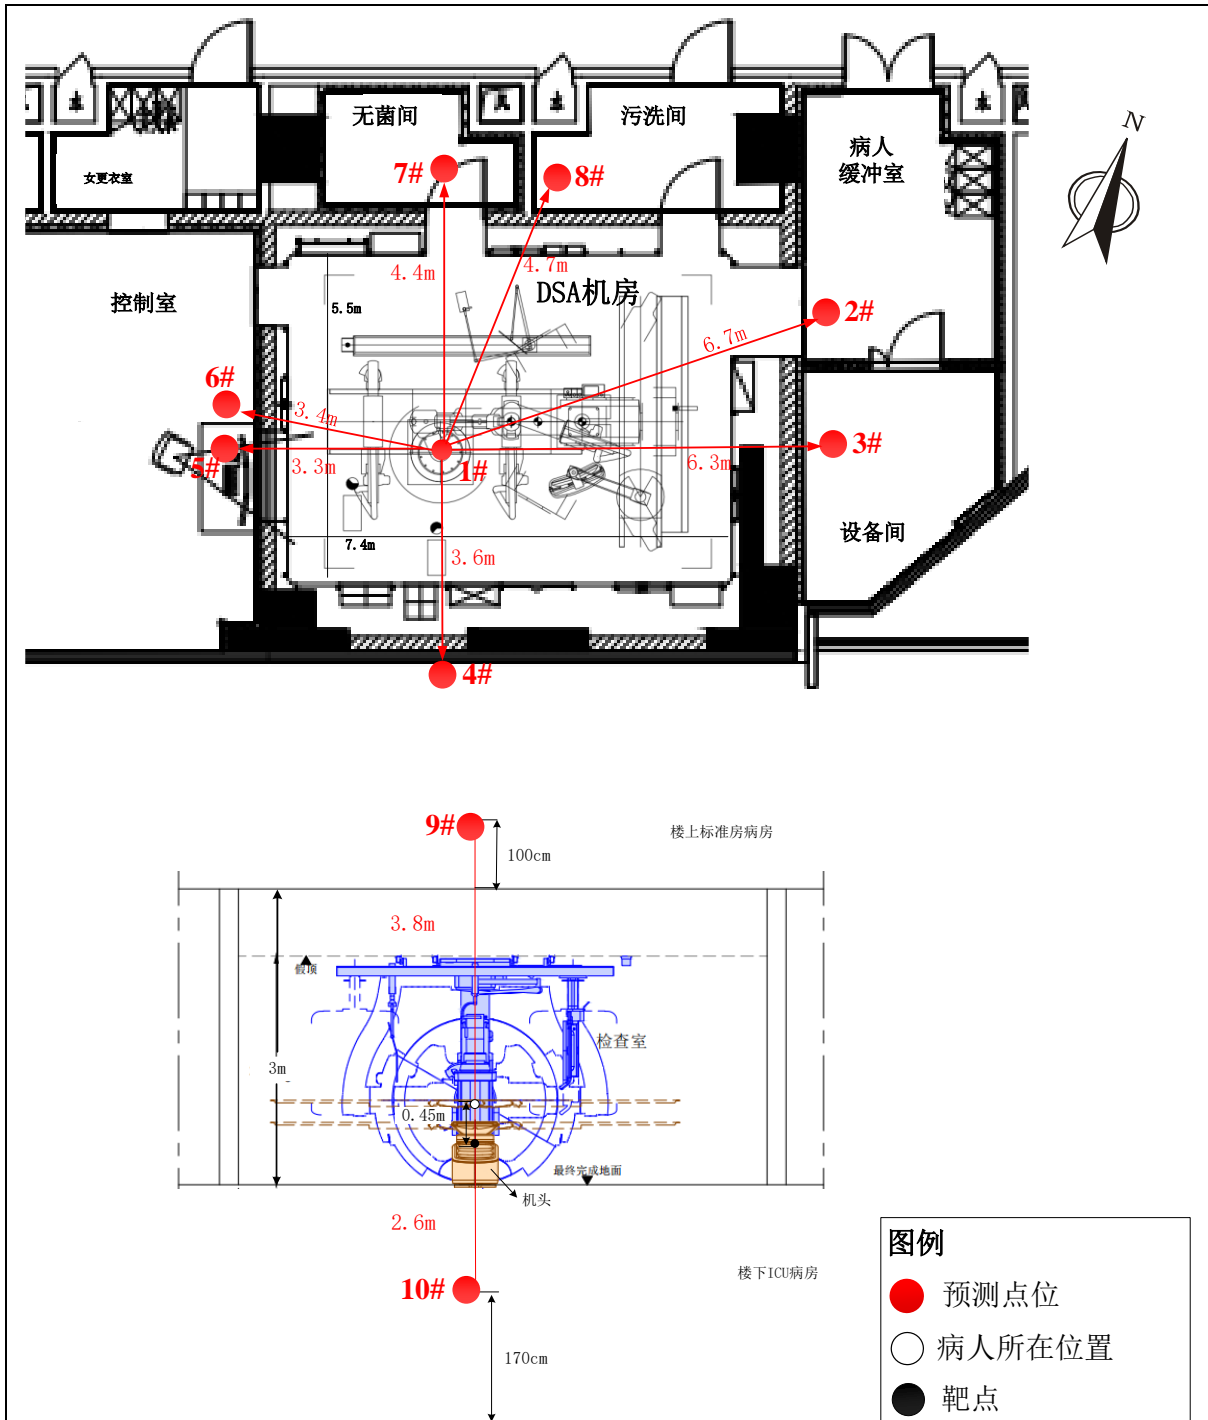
本项目DSA机房平面及剖面关注点布置示意图（距离以散射为例）
